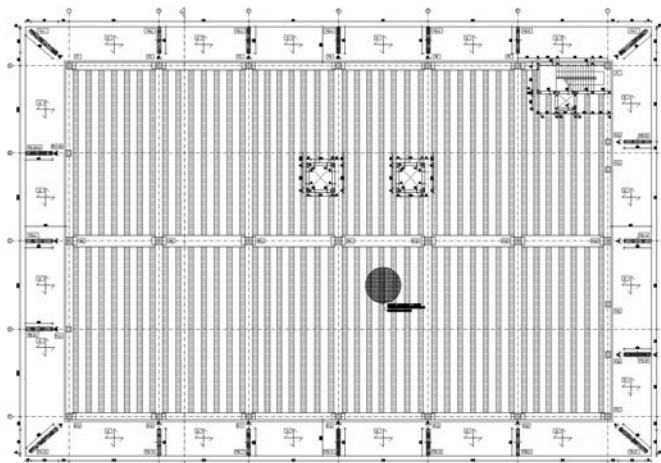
Pianta primo solaio dell'intervento di adeguamento.
